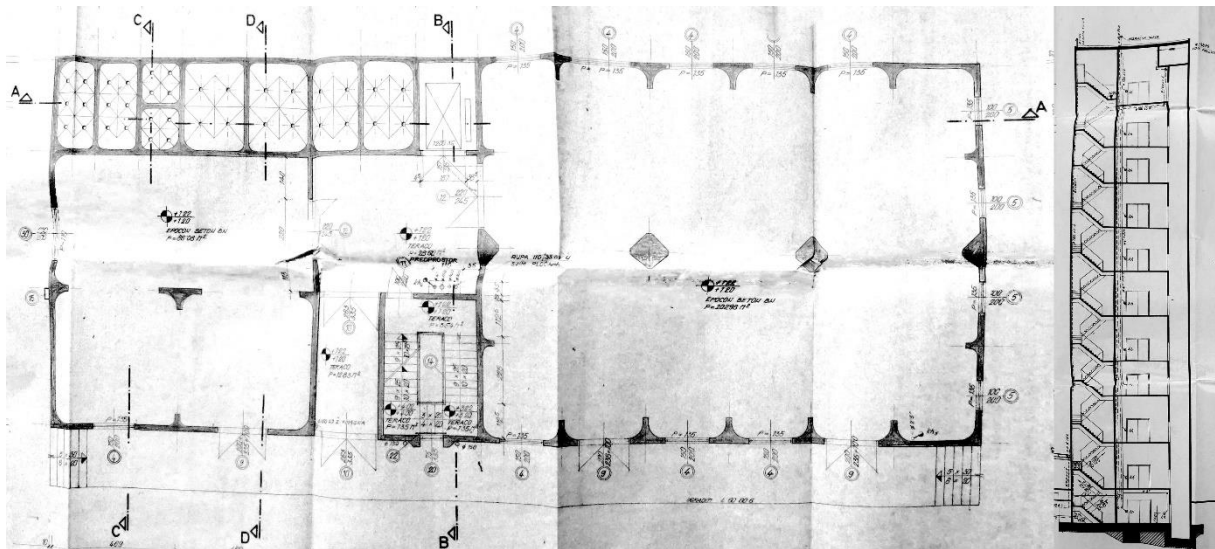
Grundriss und querschnitt des rechteckigen silo.
